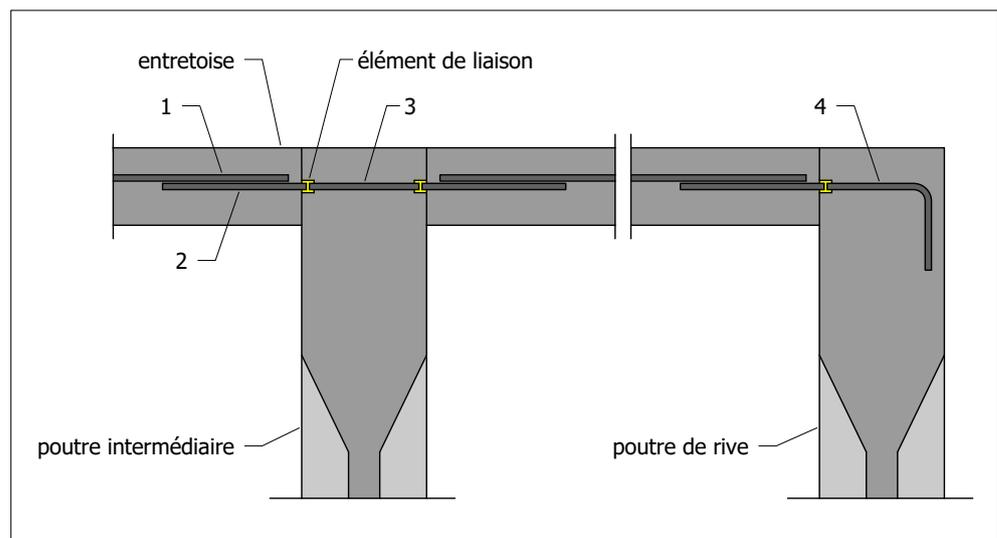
Liaisons aux blocs d'about - Vue en plan
